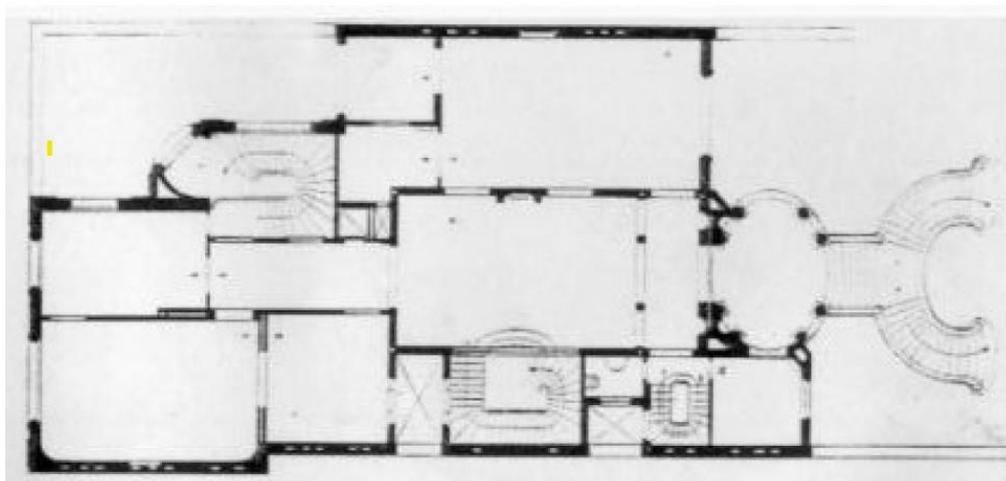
Pianta dei Petit Hotel<sup>7</sup>
